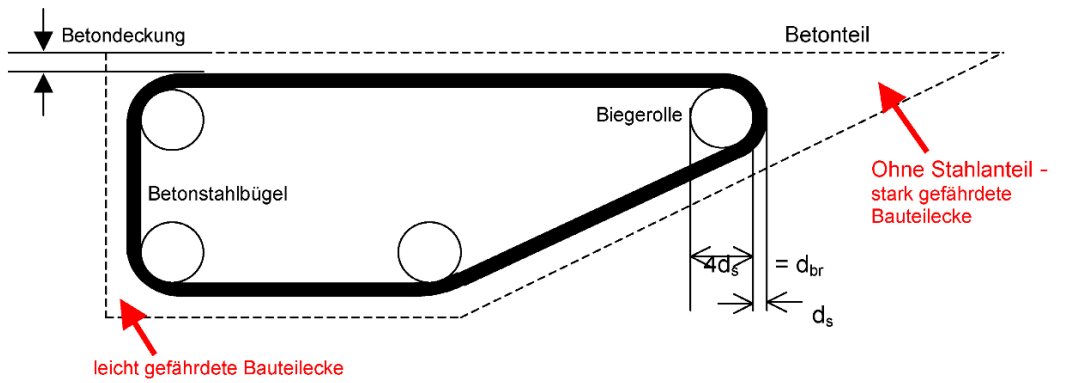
Bauteil mit eingeschlossenem Betonstahlbügel und die Konsequenzen des Biegeradienprinzips
